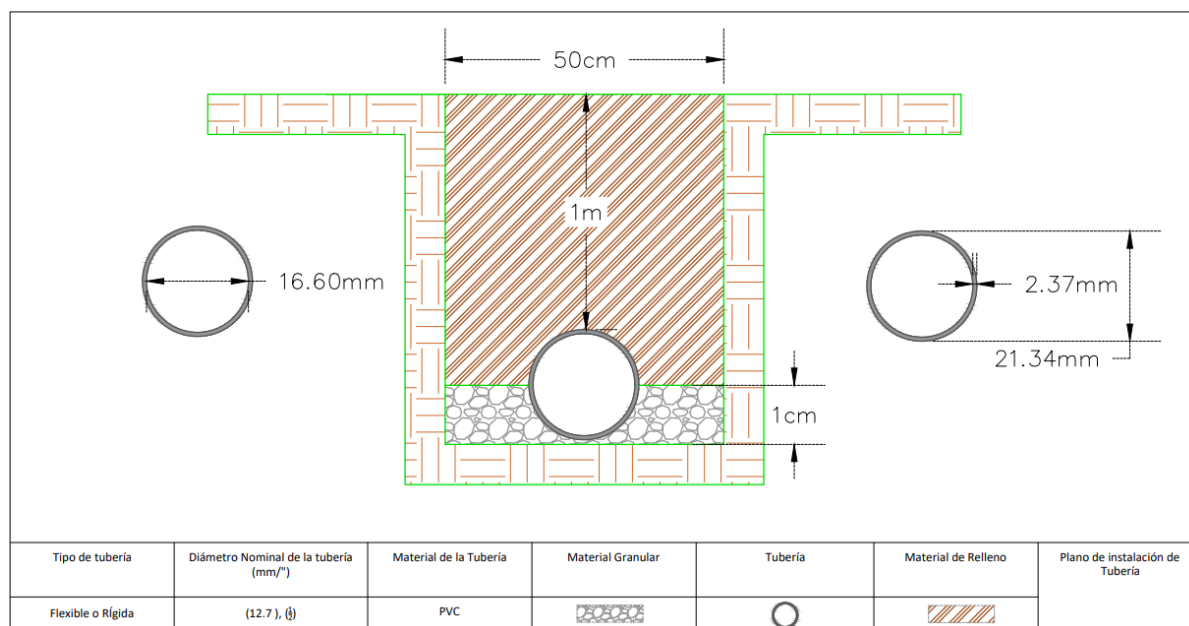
Plano de instalación de tubería; Fuente: (Carreño, 2023)
